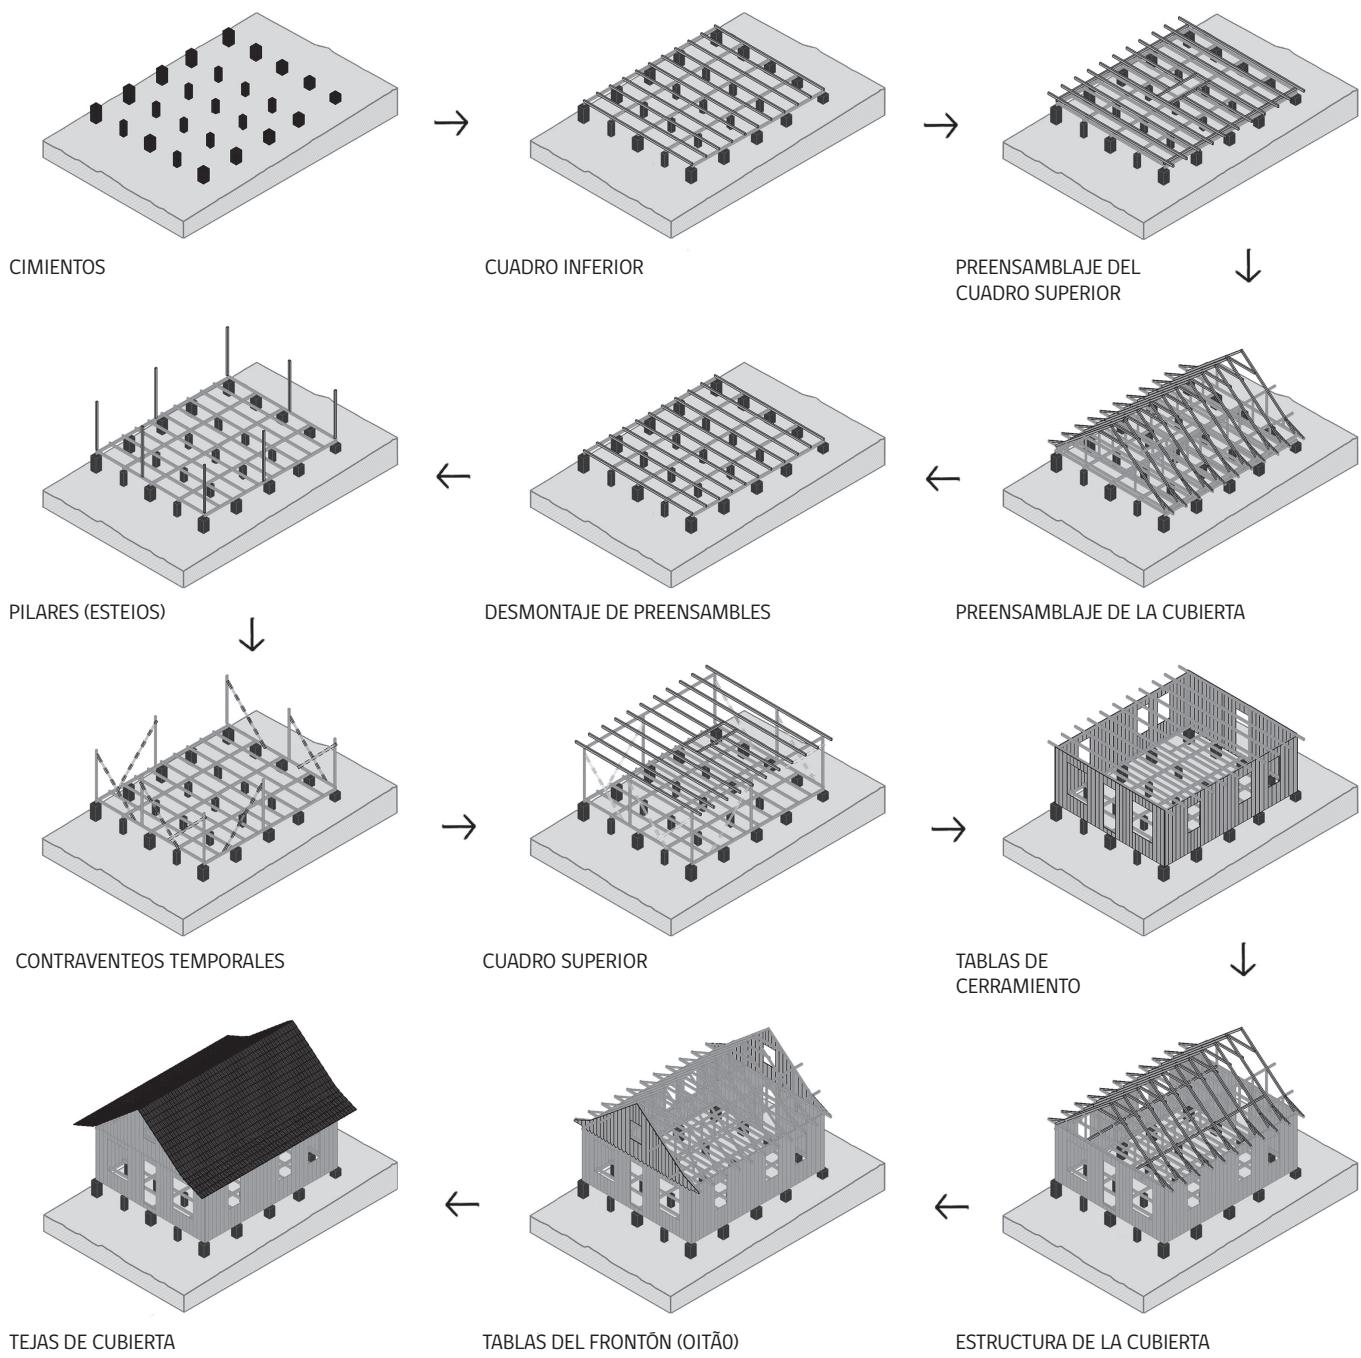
Montaje Casa Martí-Holderegger. Fuente:
